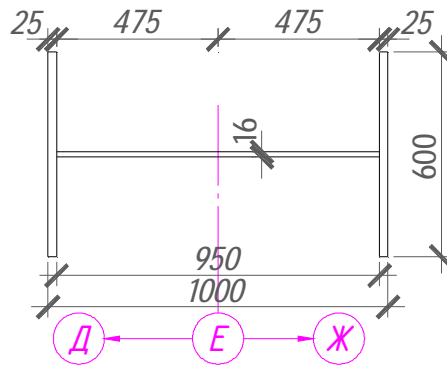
Поперечное сечение надкрановой части колонны по оси «Е» в отметках 20÷32 м.
